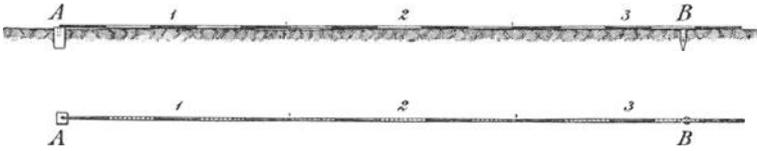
Messung einer horizontalen Länge mit Meßblättern.
